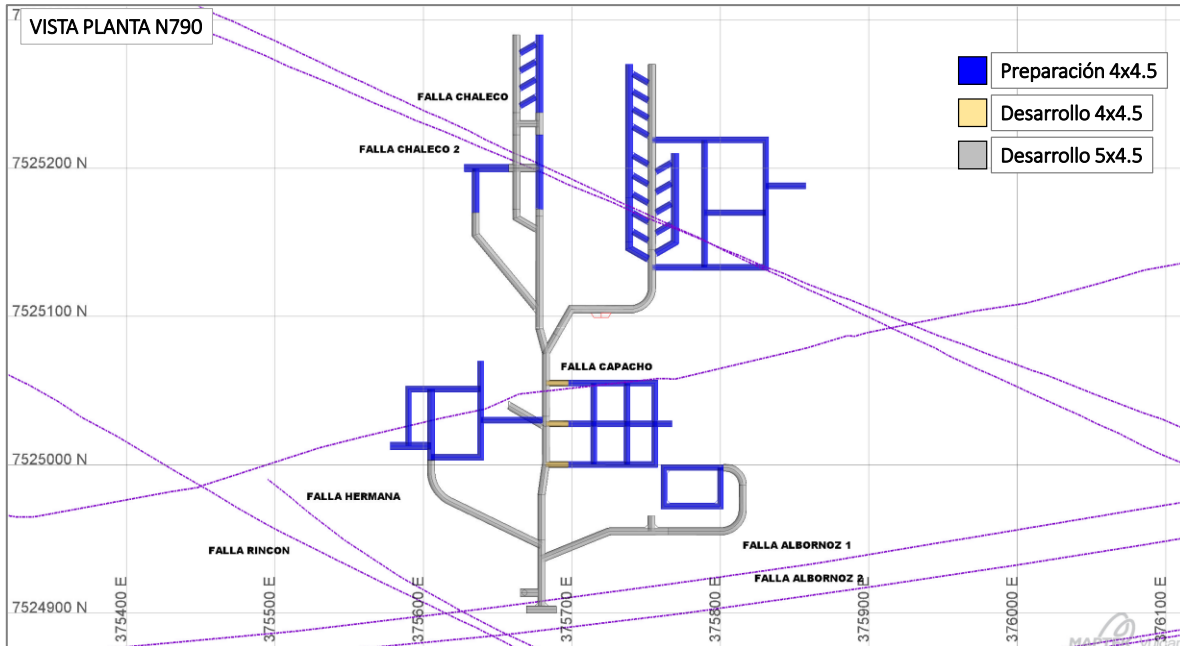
Vista planta nivel de acceso y preparación tipo para SLS.
